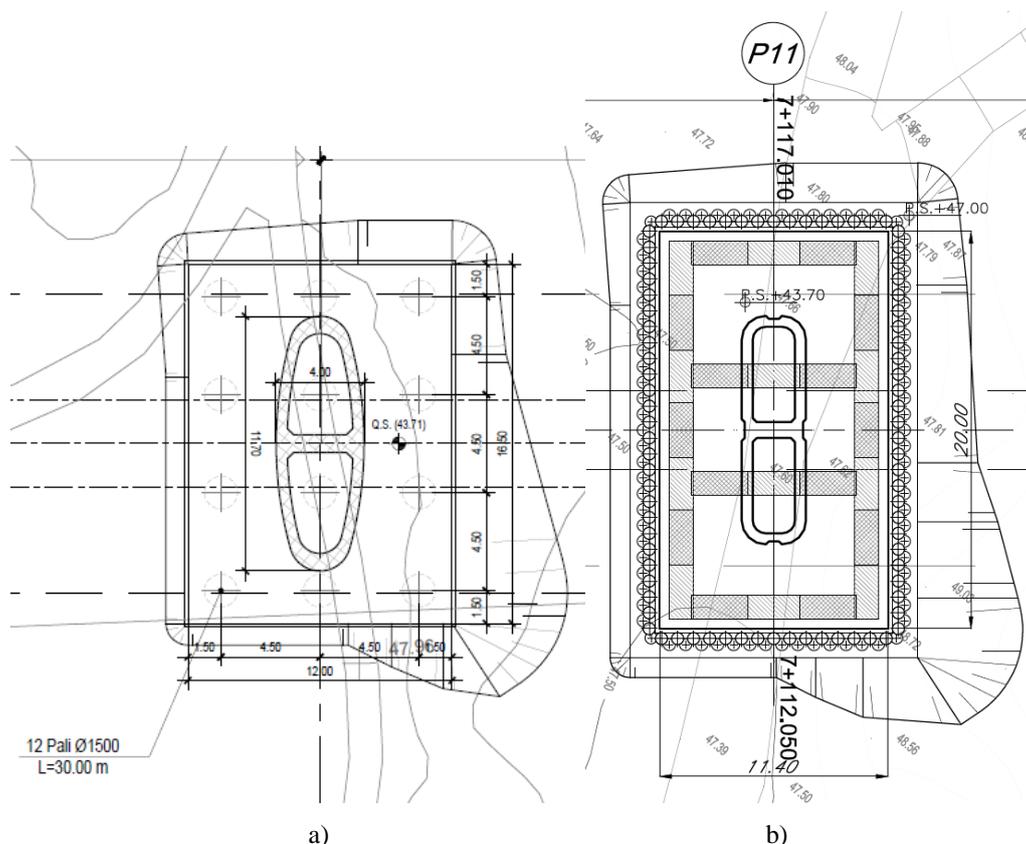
Plinti e opere provvisorie della pila P11: a) progetto esecutivo; b) progetto definitivo
